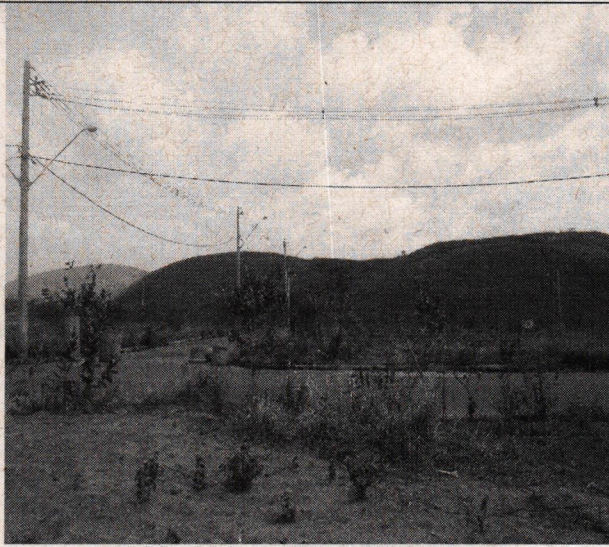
Infraestruturas (pavimentação, rede elétrica, água e esgoto) da Área 01.
